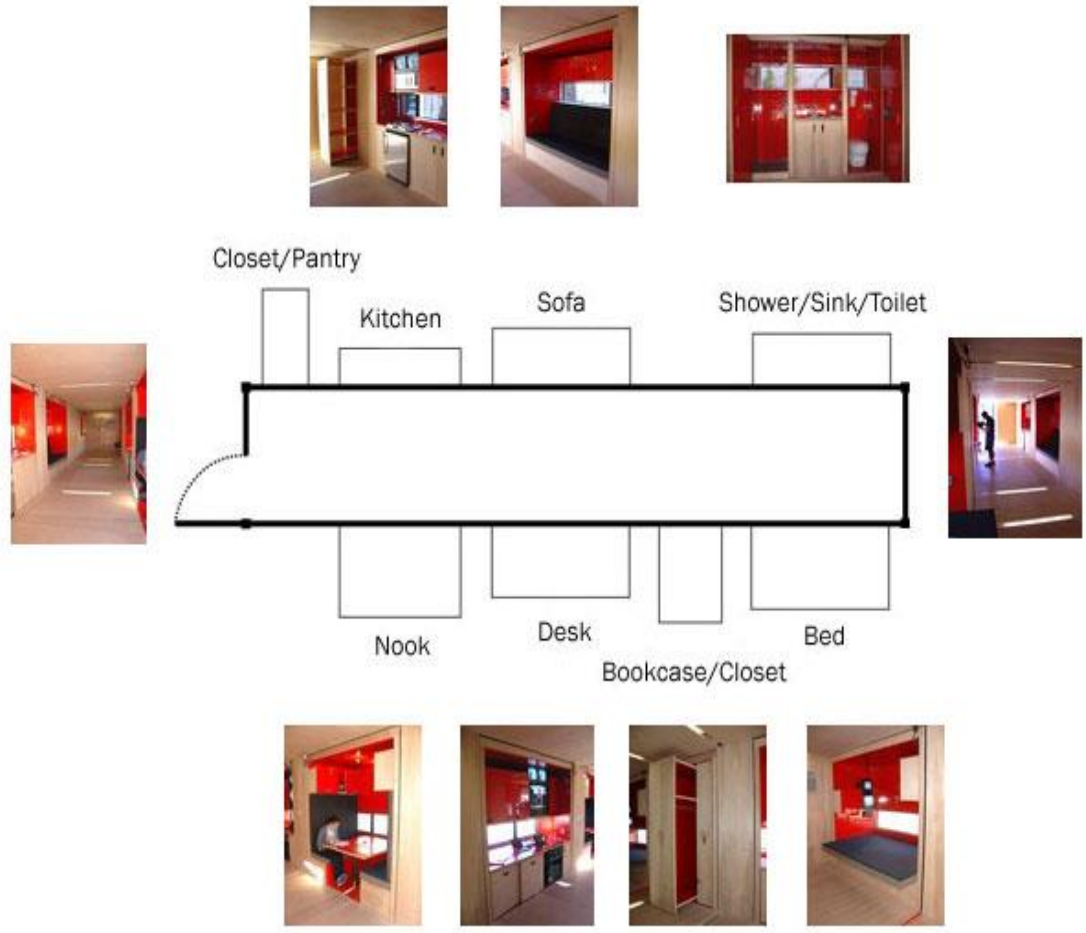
e-H VE Plan, Ünitelerin Taşınması (Segal, 2002).
